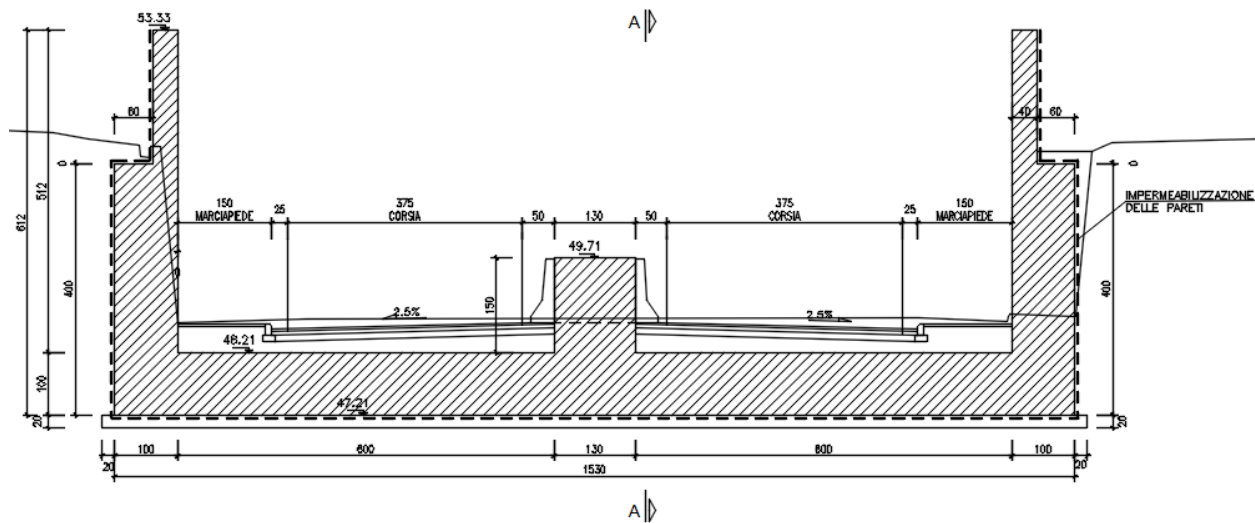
Sezione trasversale del muro ad "U" oggetto di analisi
